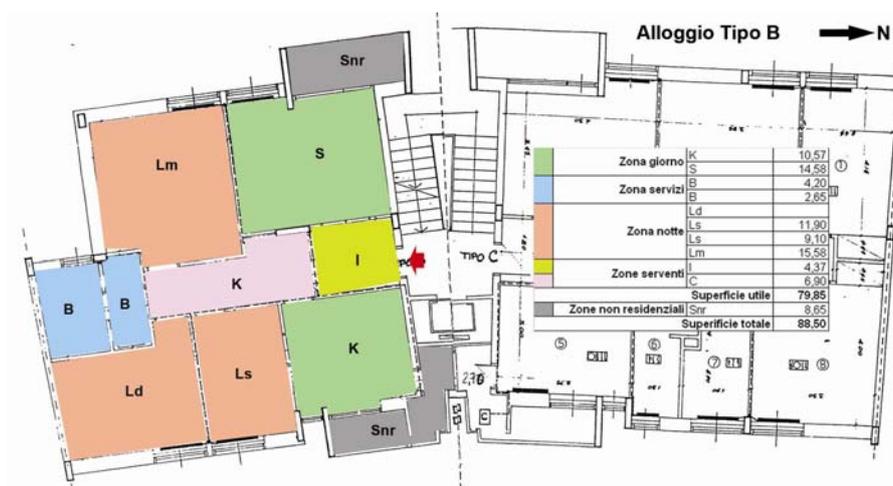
Pianta del progetto originario dell'alloggio tipo B da 80 mq per 5 persone
